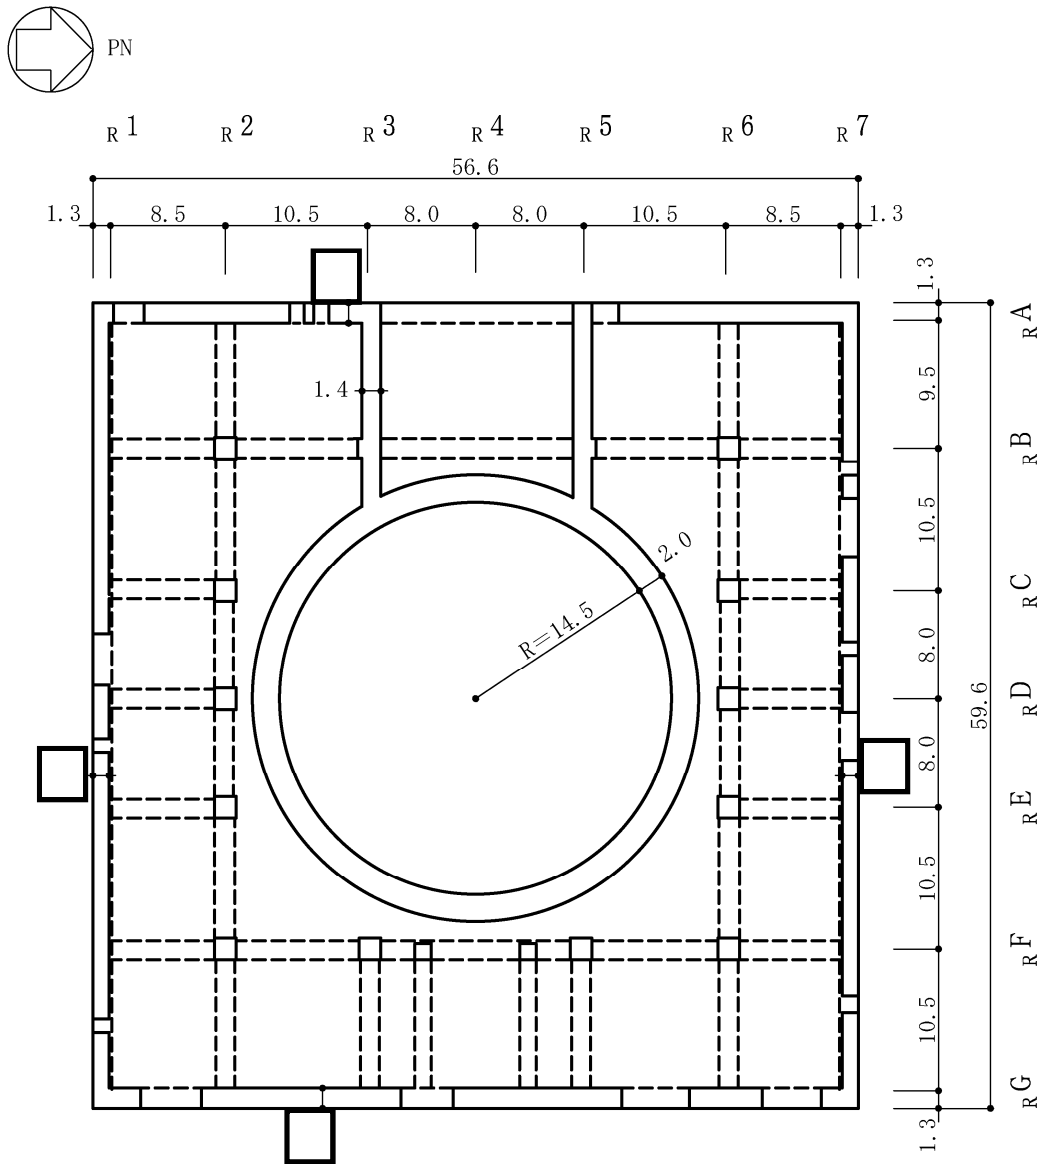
原子炉建屋の概略平面図 (1F, T. M. S. L. 12.3m) (4/9) (単位 : m)
